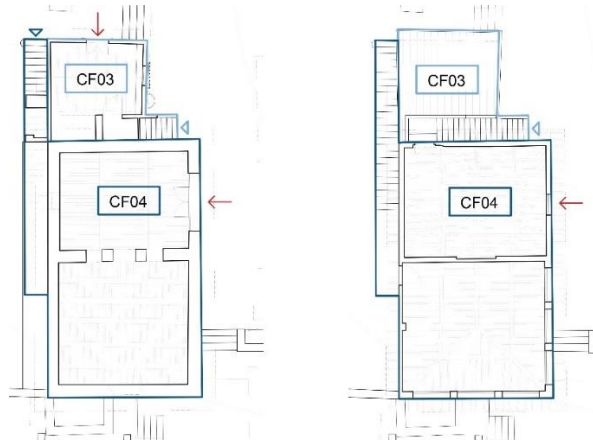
Edificio B - Suddivisione in corpi di fabbrica – da sinistra verso destra: pianta piano terra e primo
